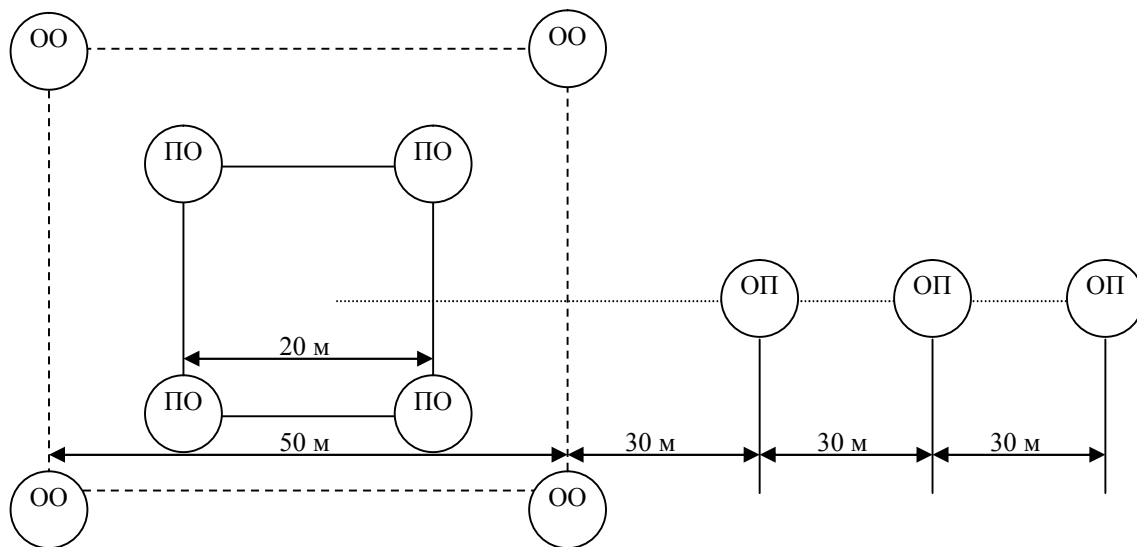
Светосигнальное оборудование вертолетной площадки.
